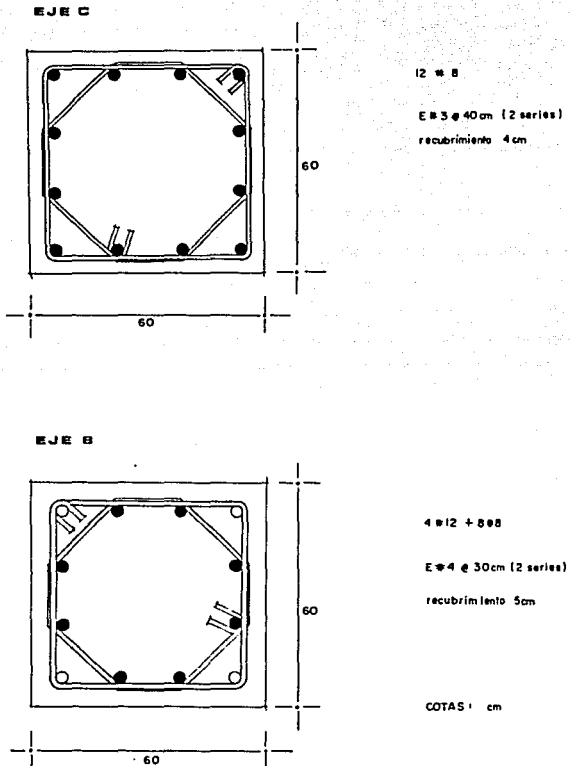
ARMADOS DE LAS SECCIONES TRANSVERSALES DE LAS COLUMNAS TIPO DE LOS EJES C Y B
